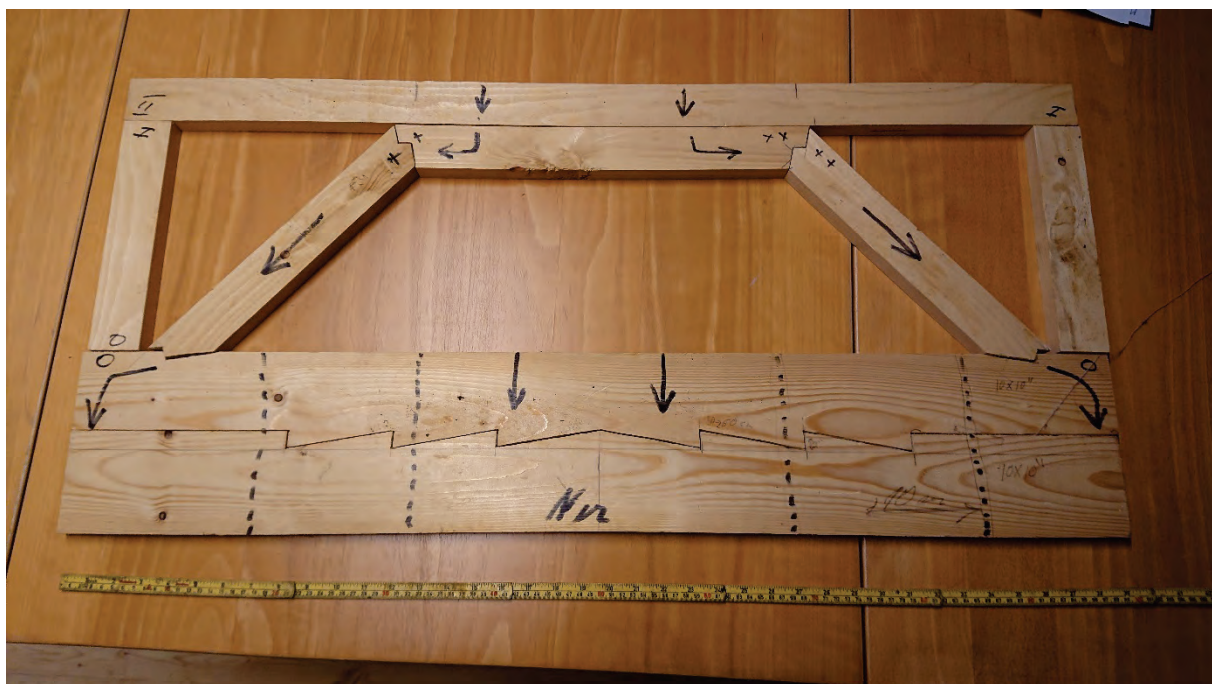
Konstruksjonen sett fra høylaet, foto PSP
